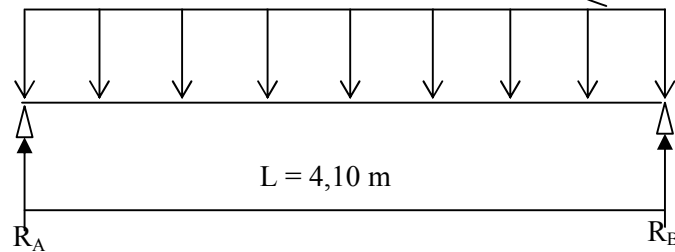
Schéma statique de la poutre palière (ELS)
